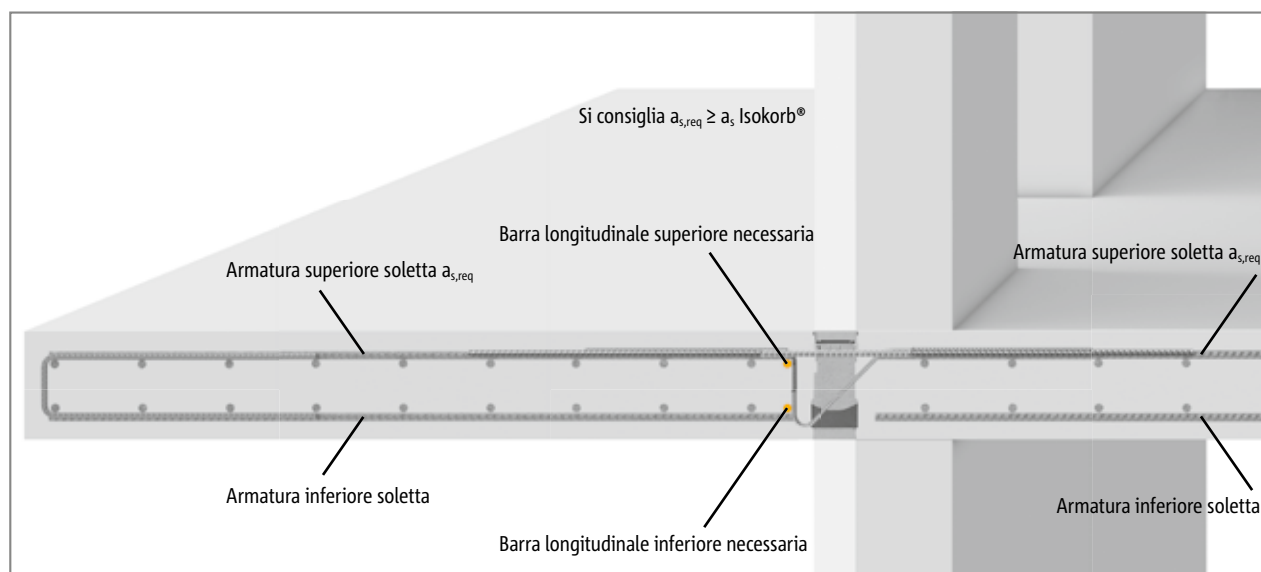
Schöck Isokorb® T tipo KL: armatura in opera con appoggio diretto
